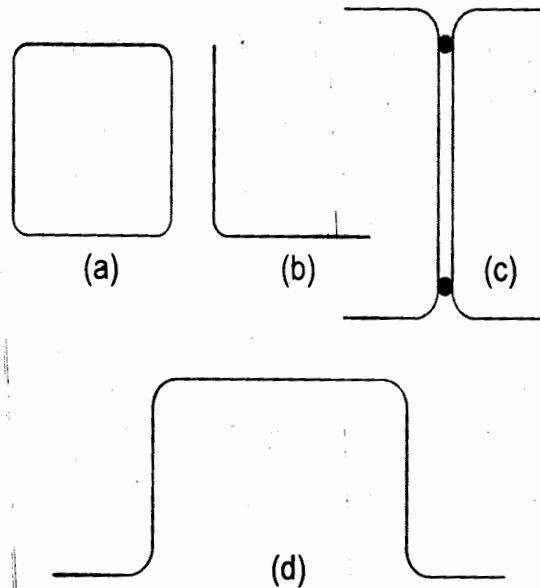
Ejemplos de secciones transversales de paredes delgadas
